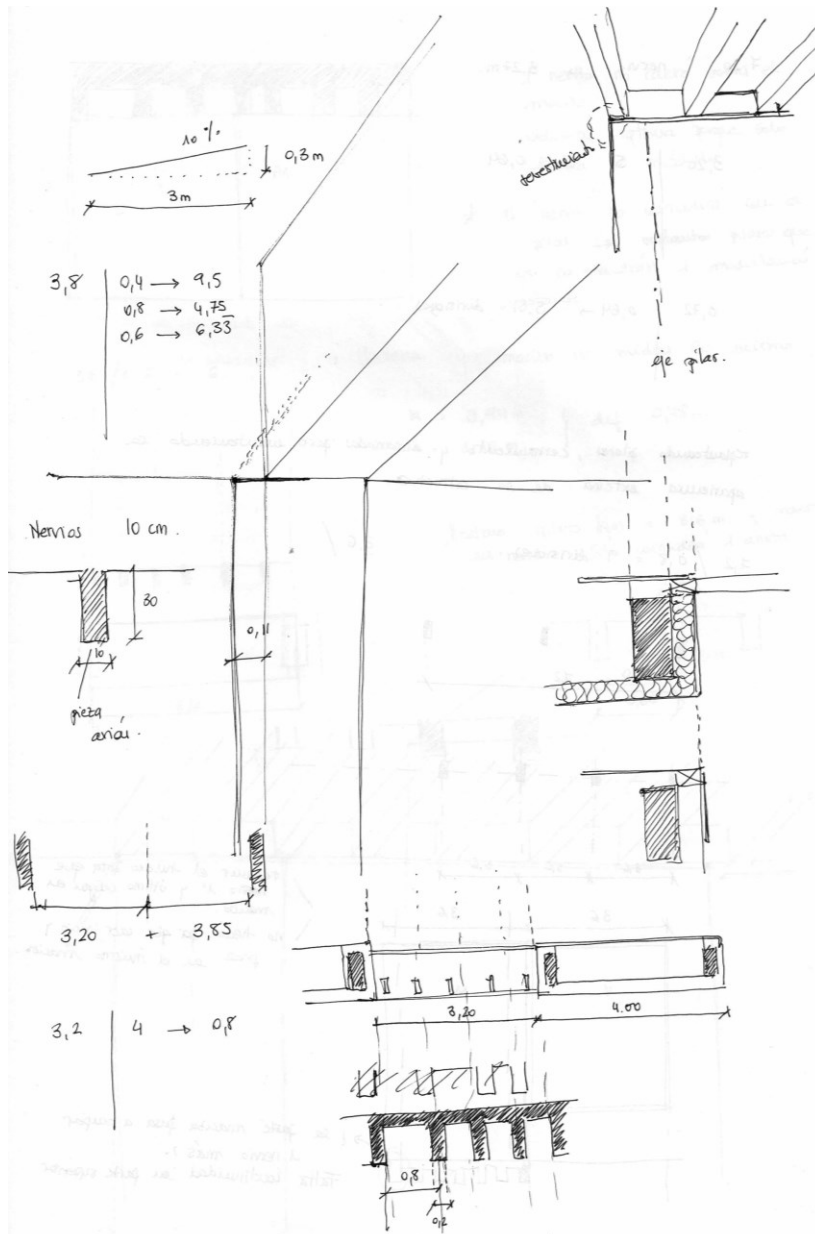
Bocetos modulación y estructura. Fuente: elaboración propia
